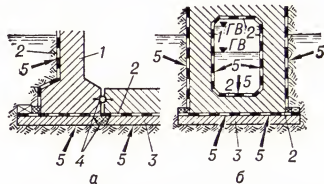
Конструкция гидроизоляции подземных сооружений: а — при одностороннем напоре воды (подвал здания); б — при двустороннем напоре воды (подземный канал); 1 — несущая конструкция; 2 — поверхностная гидроизоляция; 3 — бетонное основание; 4 — уплотнение деформационного шва; 5 — напорный фронт воды.
